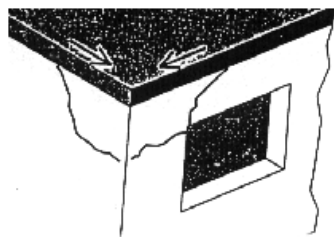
TRINCAS NA PAREDE expansão da laje
